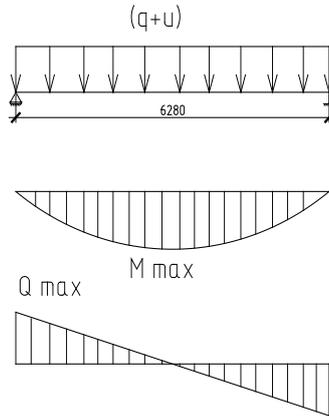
Расчетная схема плиты и эпюры усилий
